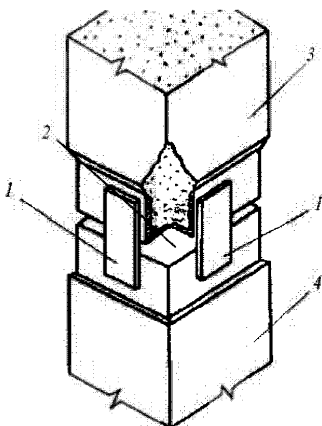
Устройство сварного стыка составных свай
